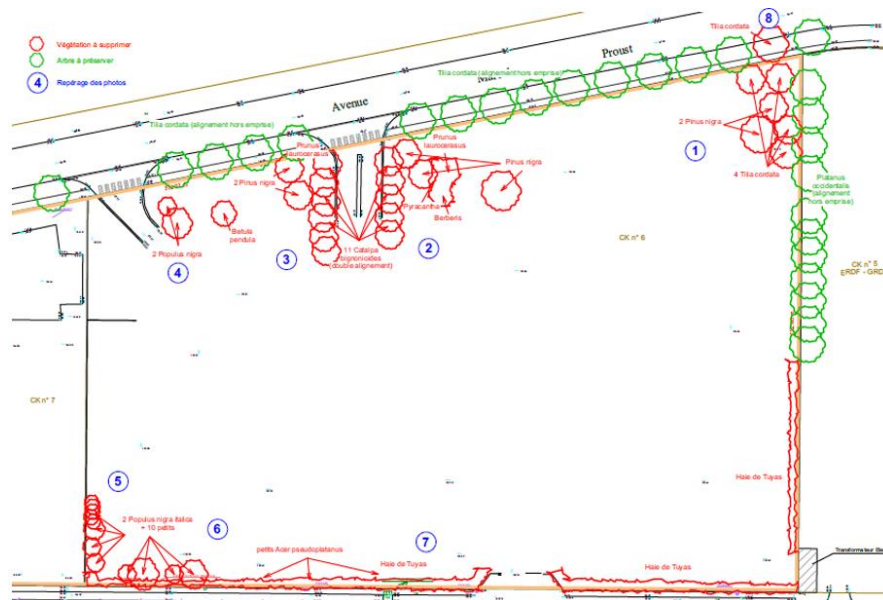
Plan des végétaux existants - (Source : A26 BLM)
